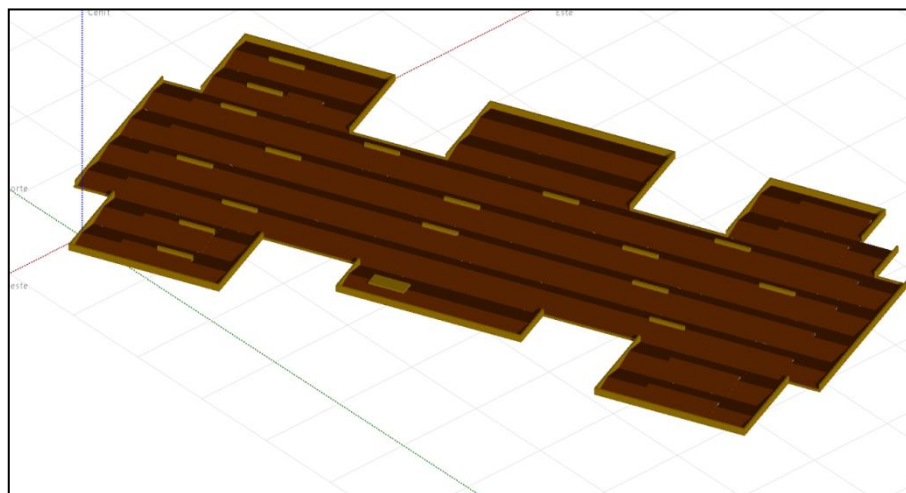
Objetos cubierta para cálculo sombreado [Elaboración propia]
